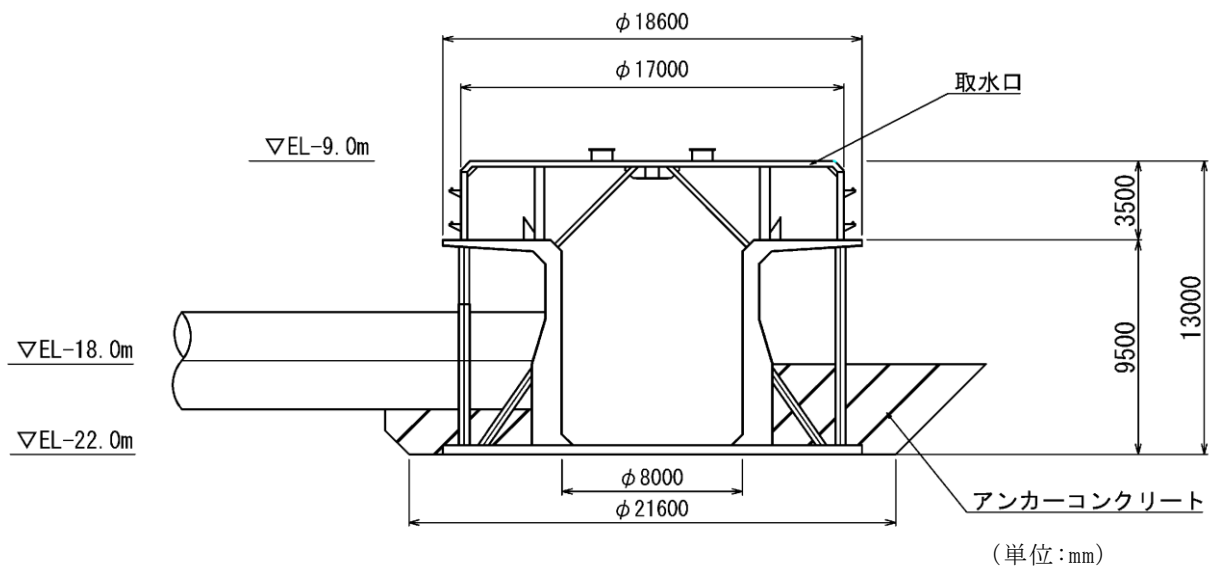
(1) 取水口 断面図 (A-A'断面)
